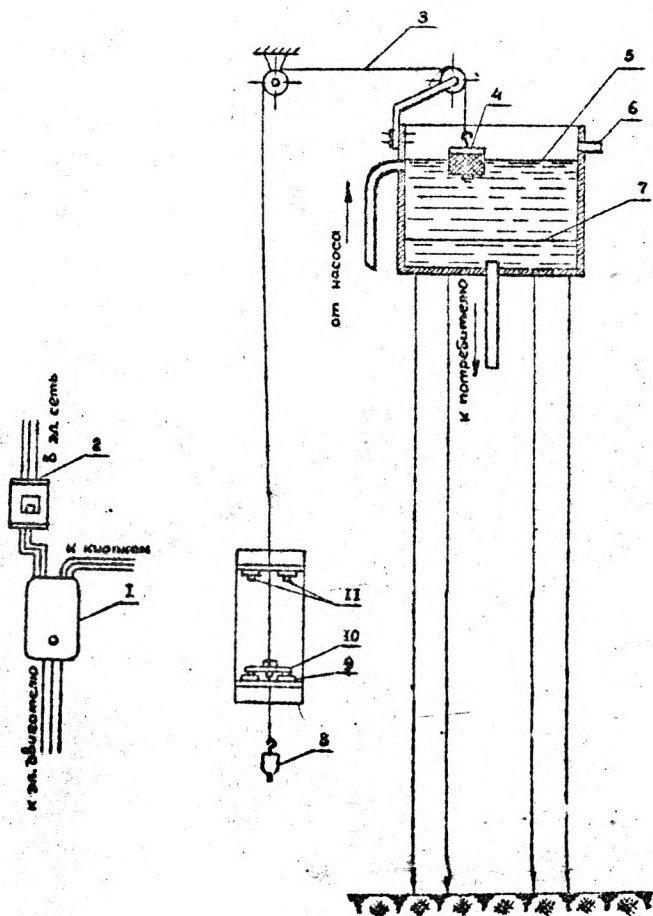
Общая схема установки: 1-магнитный пускатель; 2-рубильник или автомат; 3-капроновый трос; 4-поплавок; 5-верхний уровень; 6-сливная труба; 7-нижний уровень; 8-противовес; 9-кнопки "стоп"; 10-траверса; 11-кнопки "пуск".
